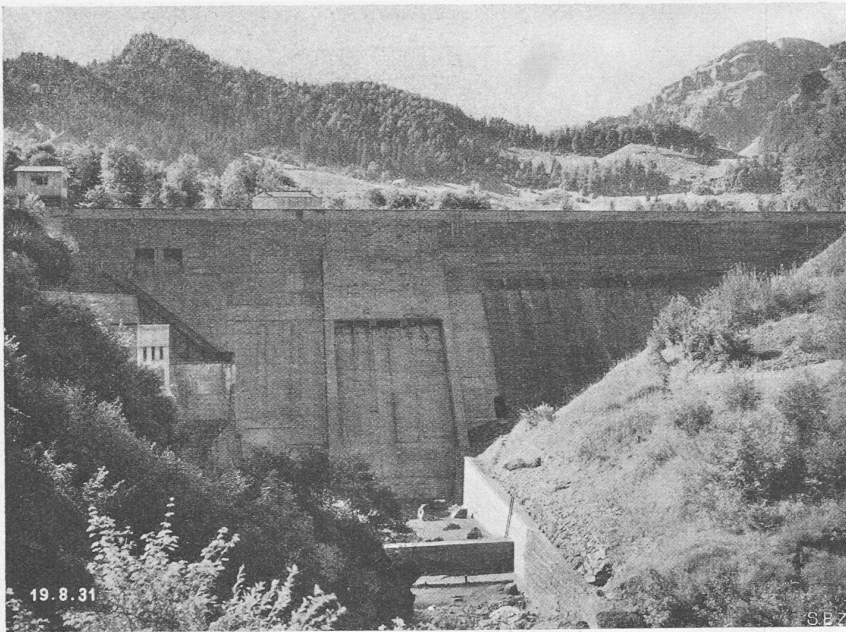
Luftseitige Ansicht der Staumauer Rempen. — 19. August 1931.
